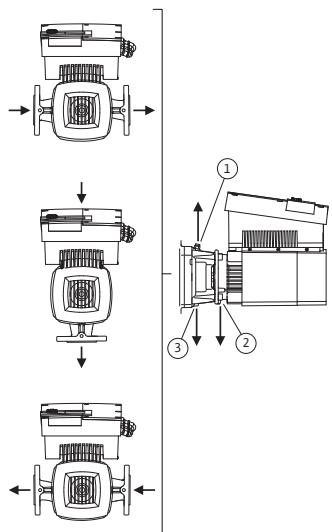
Tilladte installationspositioner med vandret motoraksel
